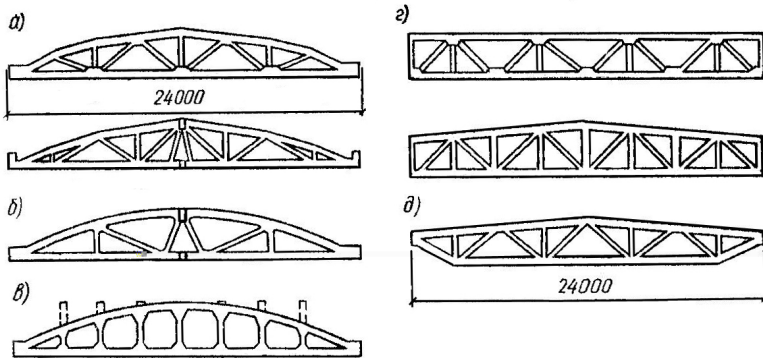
Конструктивные схемы железобетонных ферм: *а* – сегментная с верхним поясом ломаного очертания; *б* – арочная раскосная с редкой решеткой; *в* – арочная безраскосная; *г* – прямоугольного очертания с параллельными поясами и трапециевидного очертания с уклонами верхнего пояса; *д* – полигональная с ломаным нижним поясом
